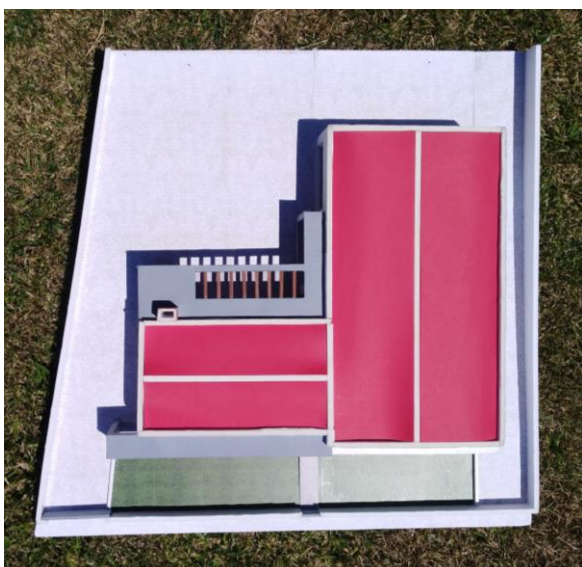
Maquete: vista da moradia no terreno (maio de 2020). Fonte: Autor.
